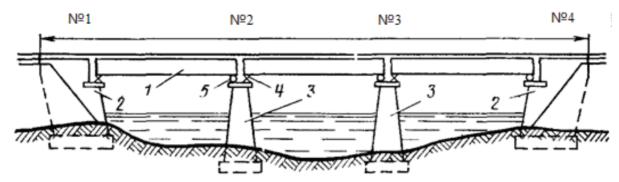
Схема мостового перехода: 1 – пролетное строение; 2 – устои(№1, №4); 3 – быки (№2, №3); 4 –неподвижные опорные части; 5 –подвижные опорные части
